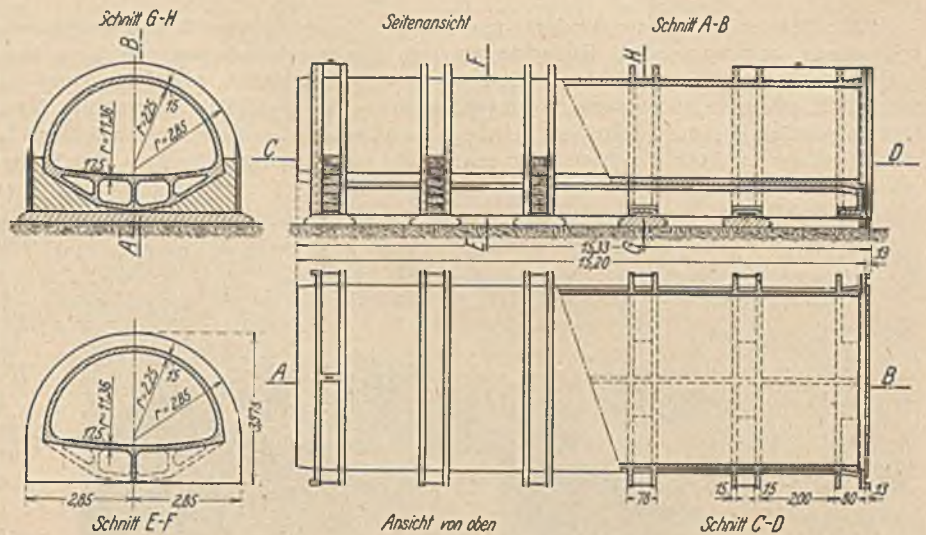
Eisenbetonrohr der Unterwasserstrecke.
